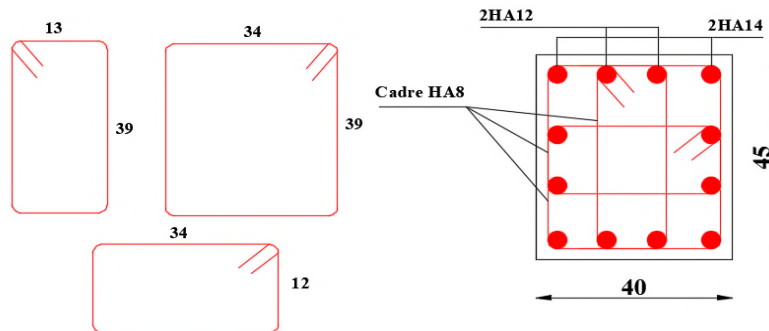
Schéma de ferrailage des poteaux étages 2 et 3
